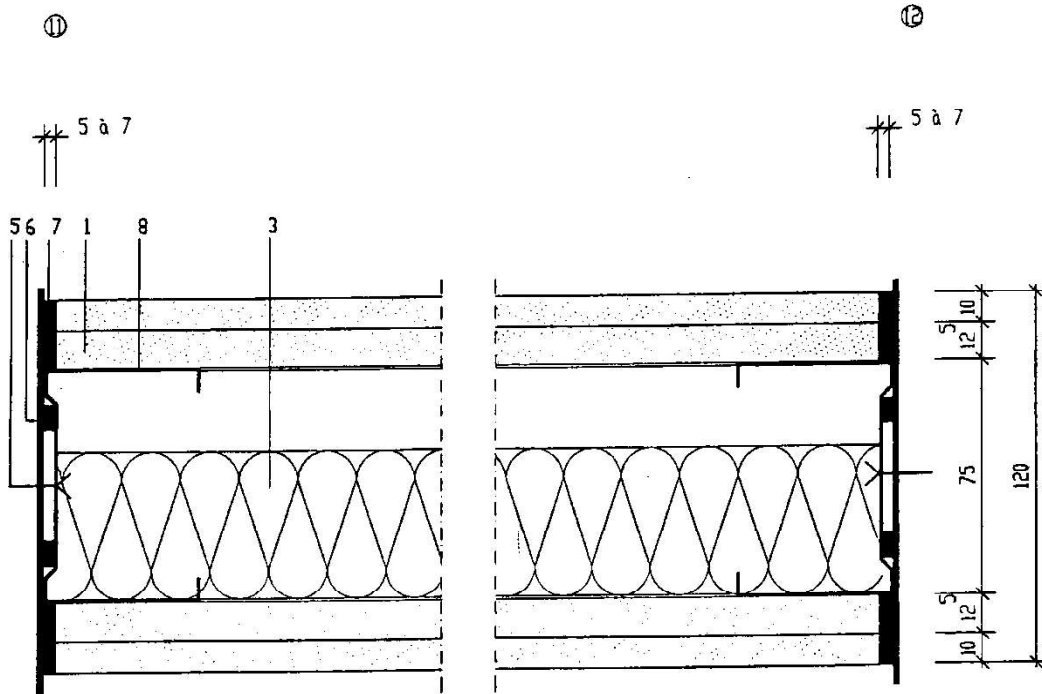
/8: "Zijaansluiting 1S15 en 1S11 wand"
